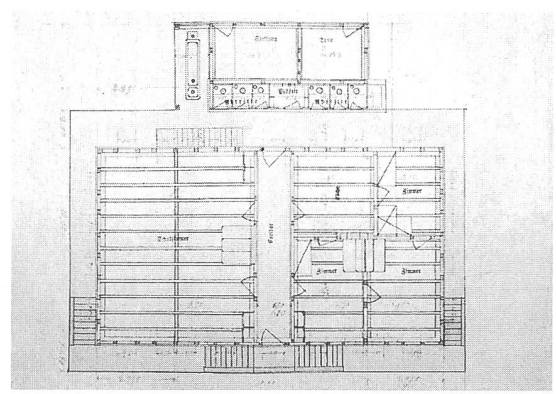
Trub, Schulhaus Ried. Grundriss des Erdgeschosses, 1898, A. Brechbühl. Ein Korridor trennt Schulzimmer und Wohnung. Im Anbau befinden sich Toiletten, Stall und Tenn. (Gemeindearchiv Trub)
